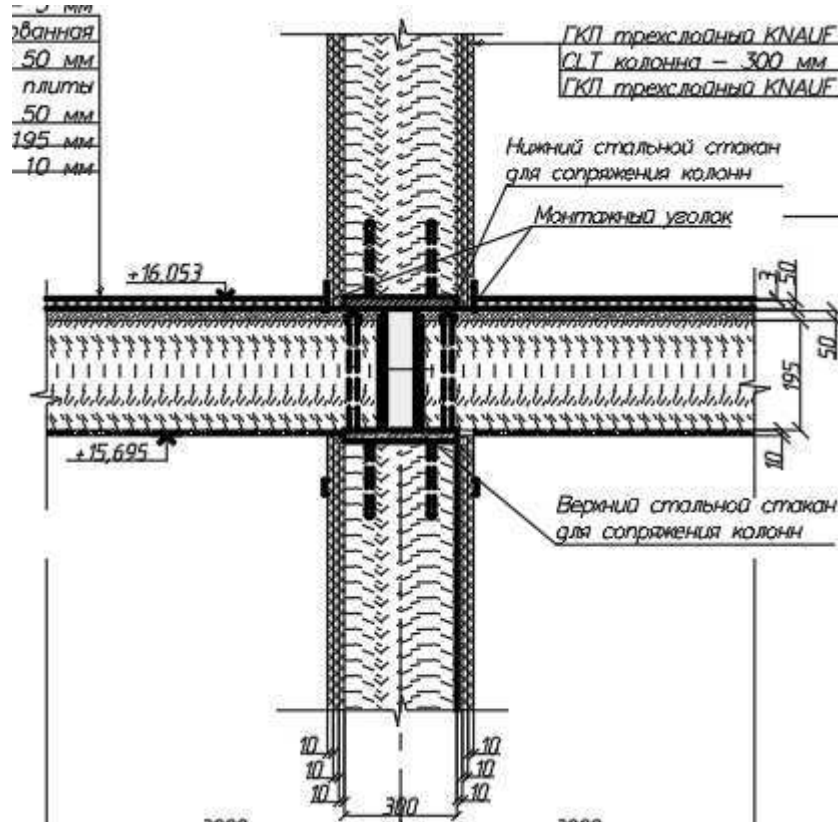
Узел опирания плиты перекрытия на колонну.
